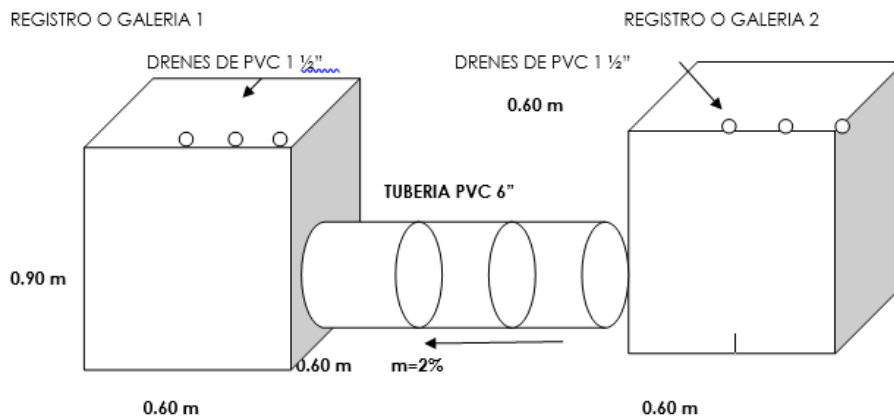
Detalle de colocación de drenes en muro vertical de registro.
